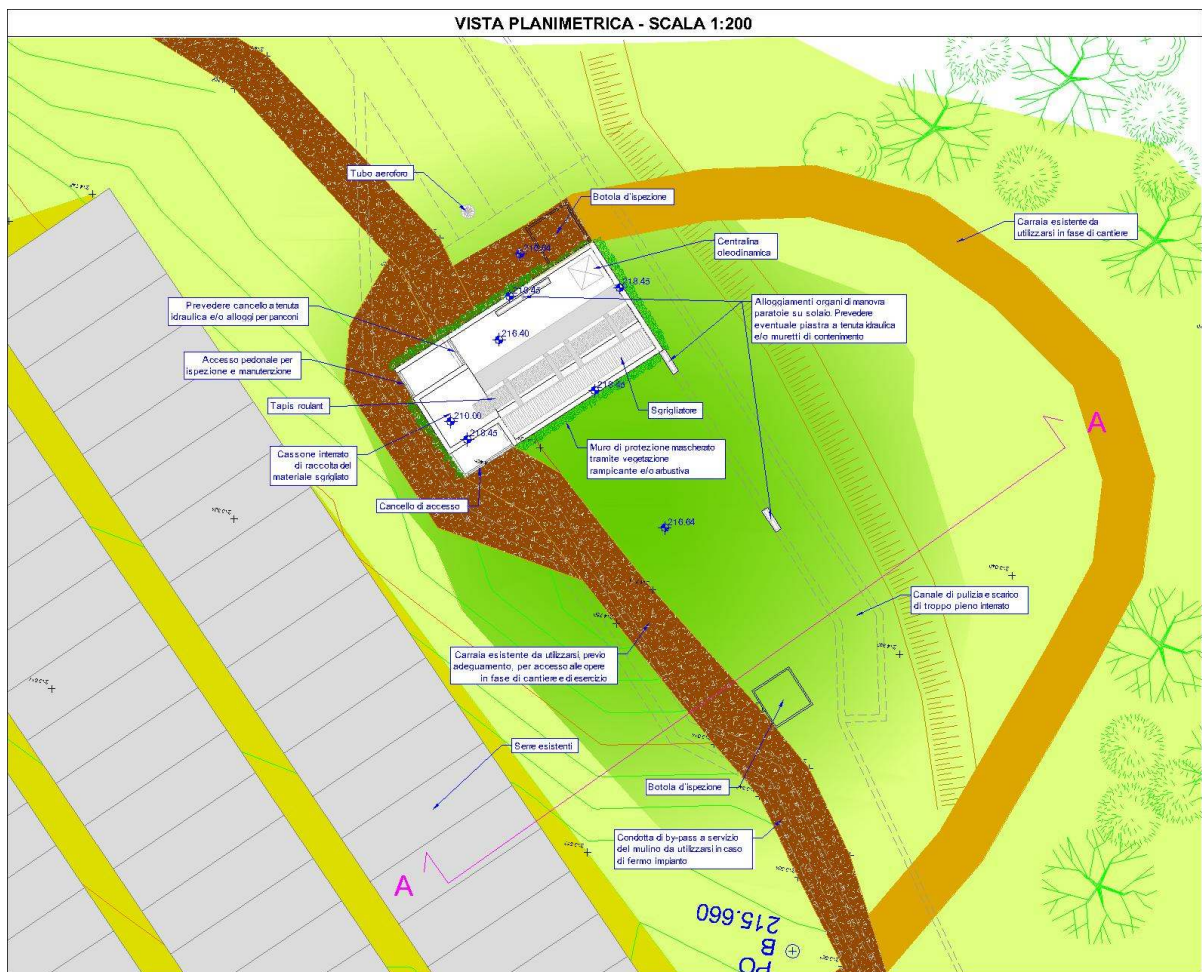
vista planimetrica zona dissabbiatore – estratto tavola integrativa 6.1
